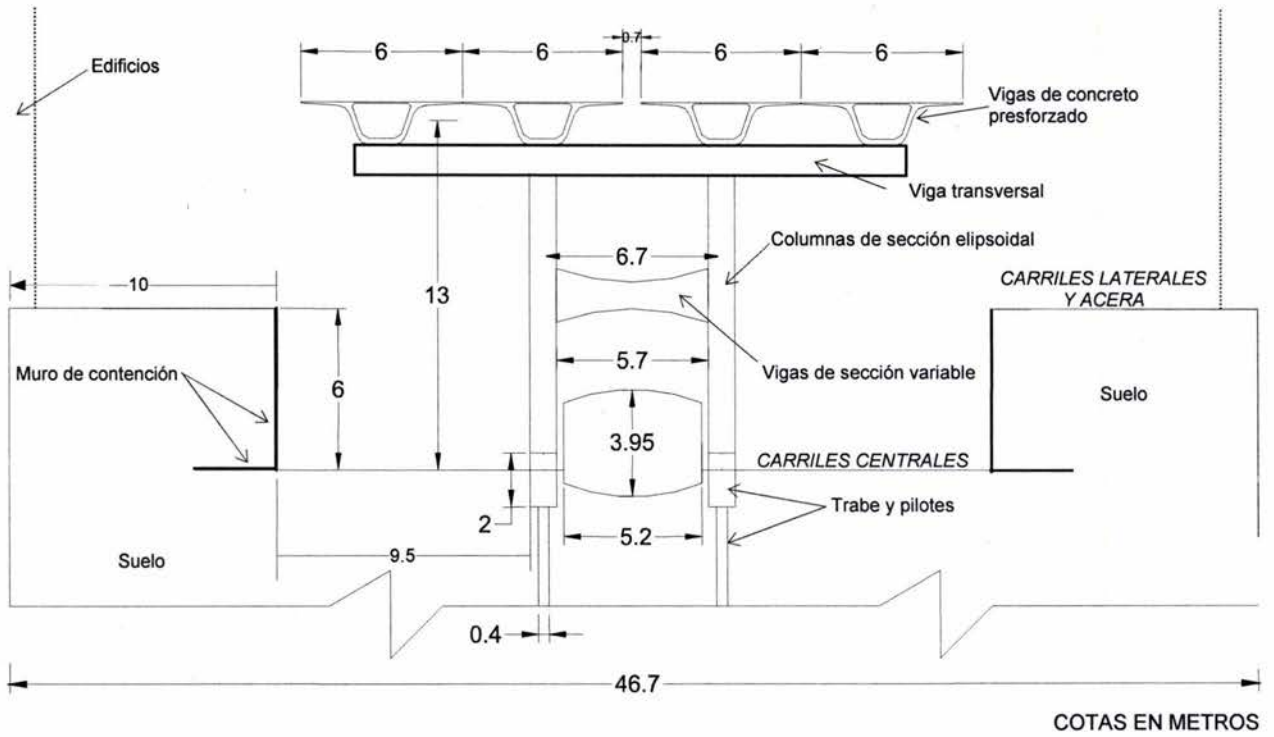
Propuesta para segundo nivel del Viaducto de la Ciudad de México.
